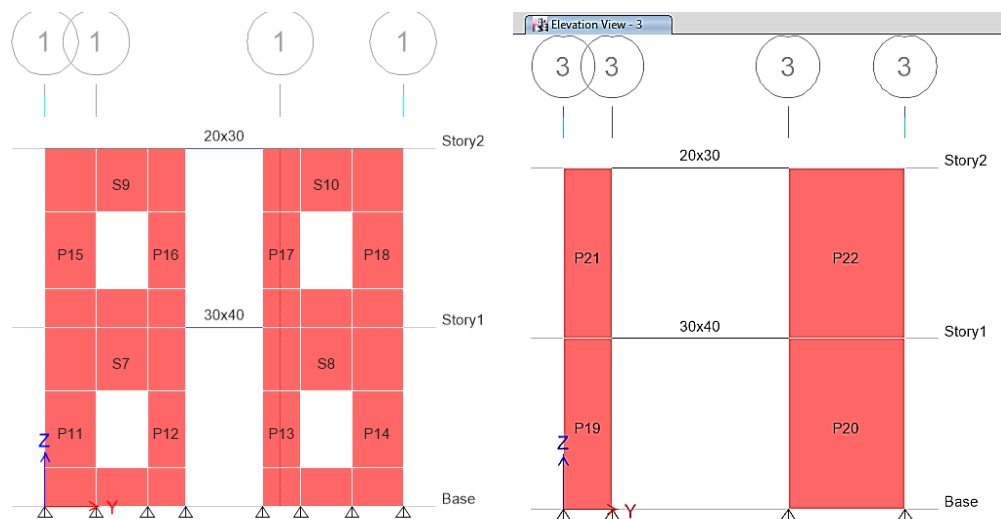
Refuerzo longitudinal en $[cm^2]$ para Muros del EJE 1 y 3.
